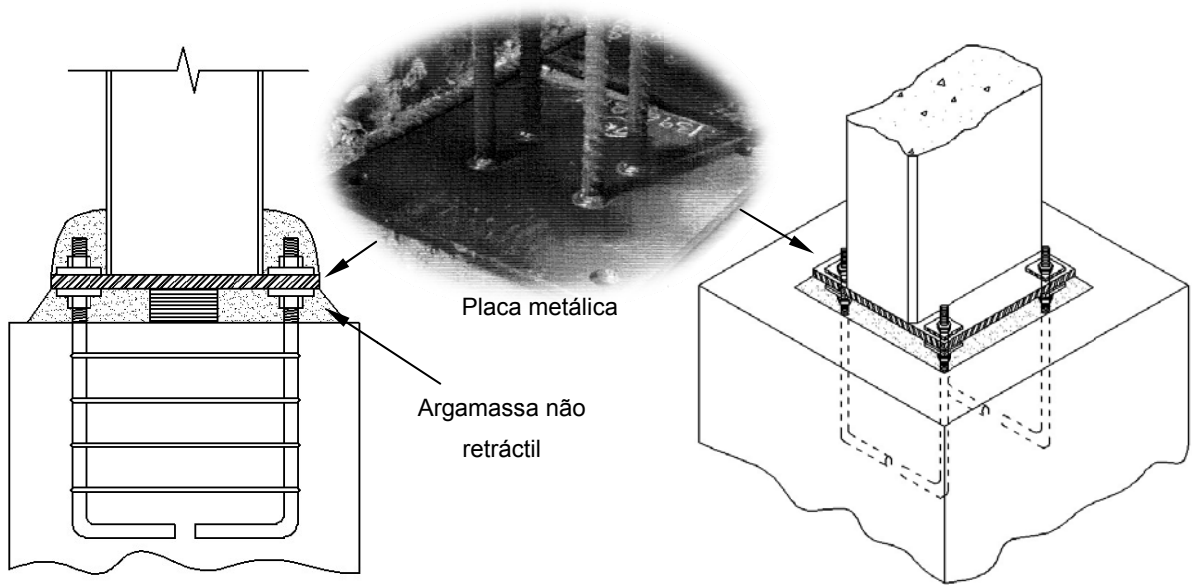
Ligação pilar – fundação através de placas metálicas
